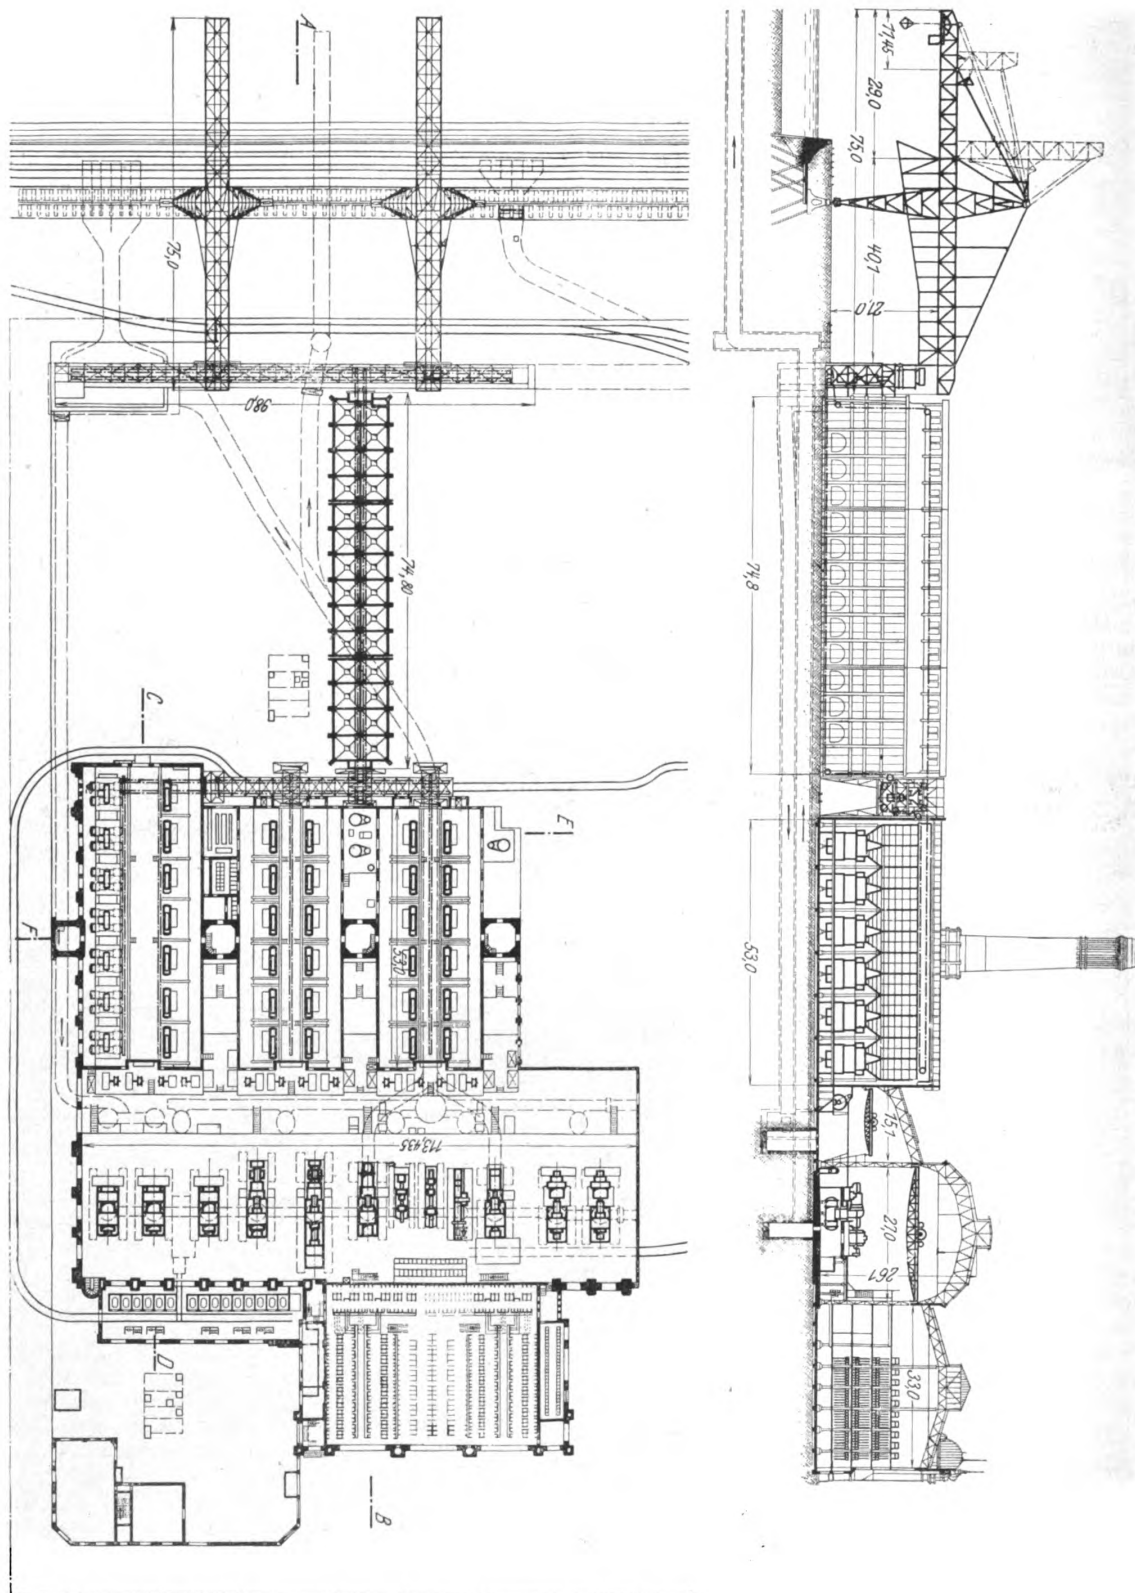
u. 3. Kraftwerk Dock Süd. Fig. 2. Schnitt A-B. Fig. 3. Grundriss.
